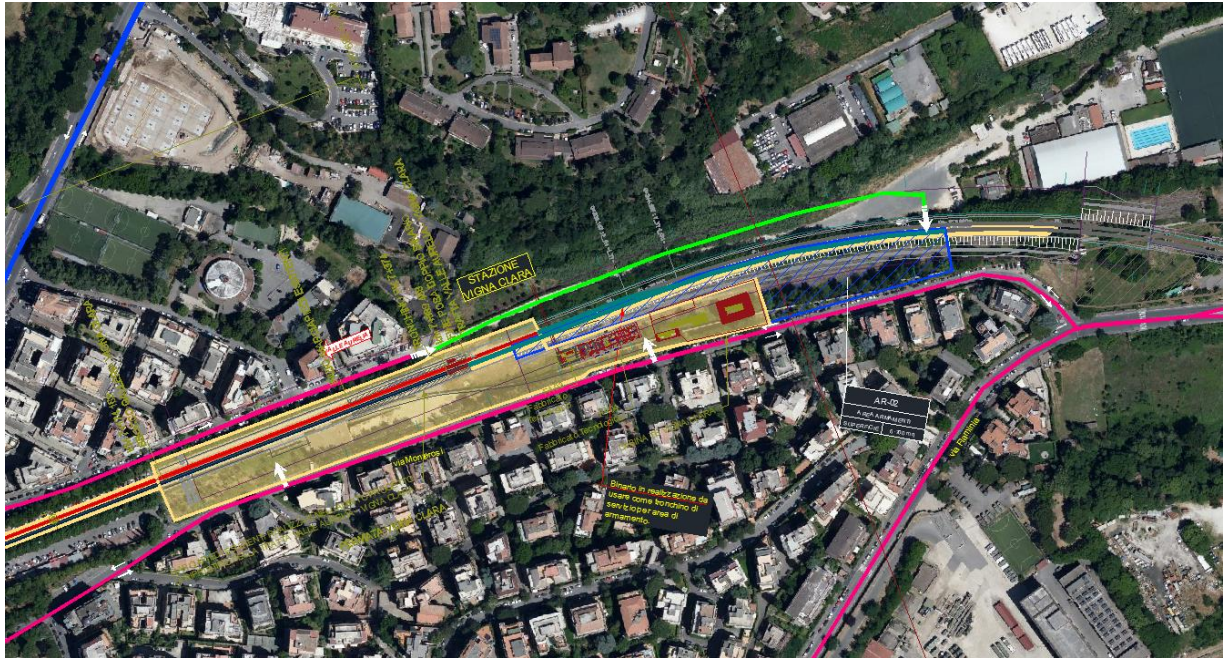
Stralcio planimetrico dell'opera oggetto di studio nel primo contesto ambientale
